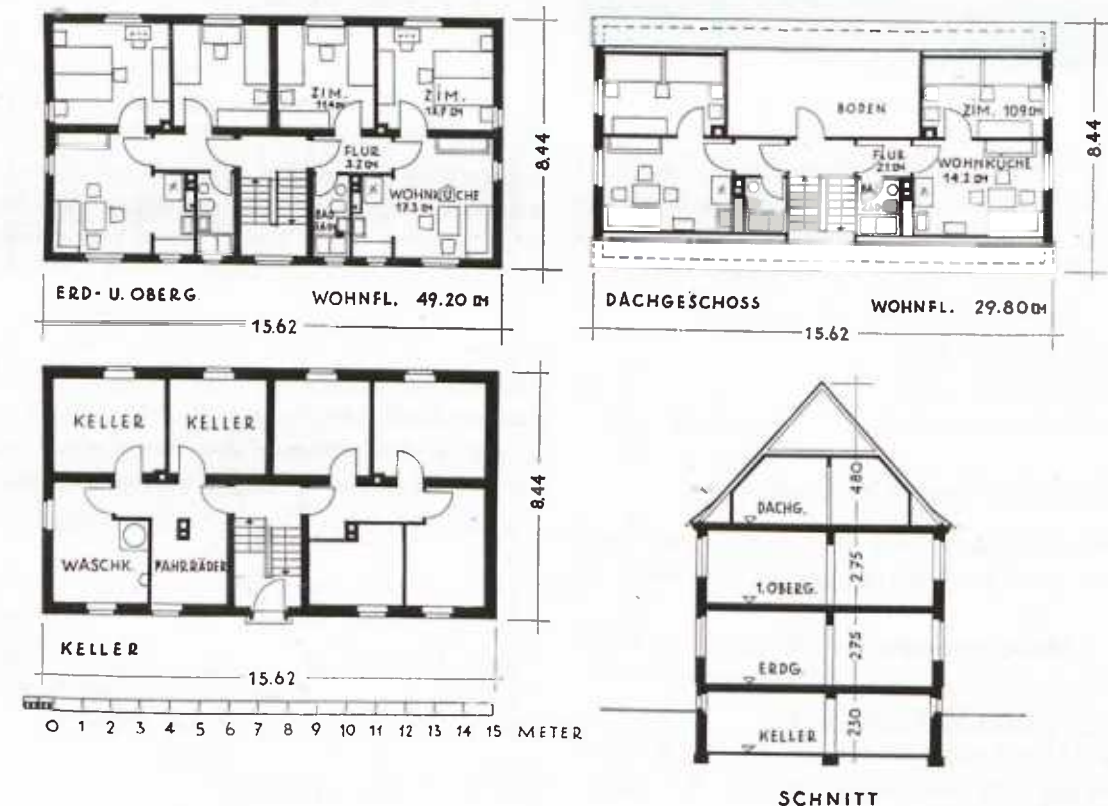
Versuchsbauten am Judensand. Zweispänner. Grundrisse und Schnitt
